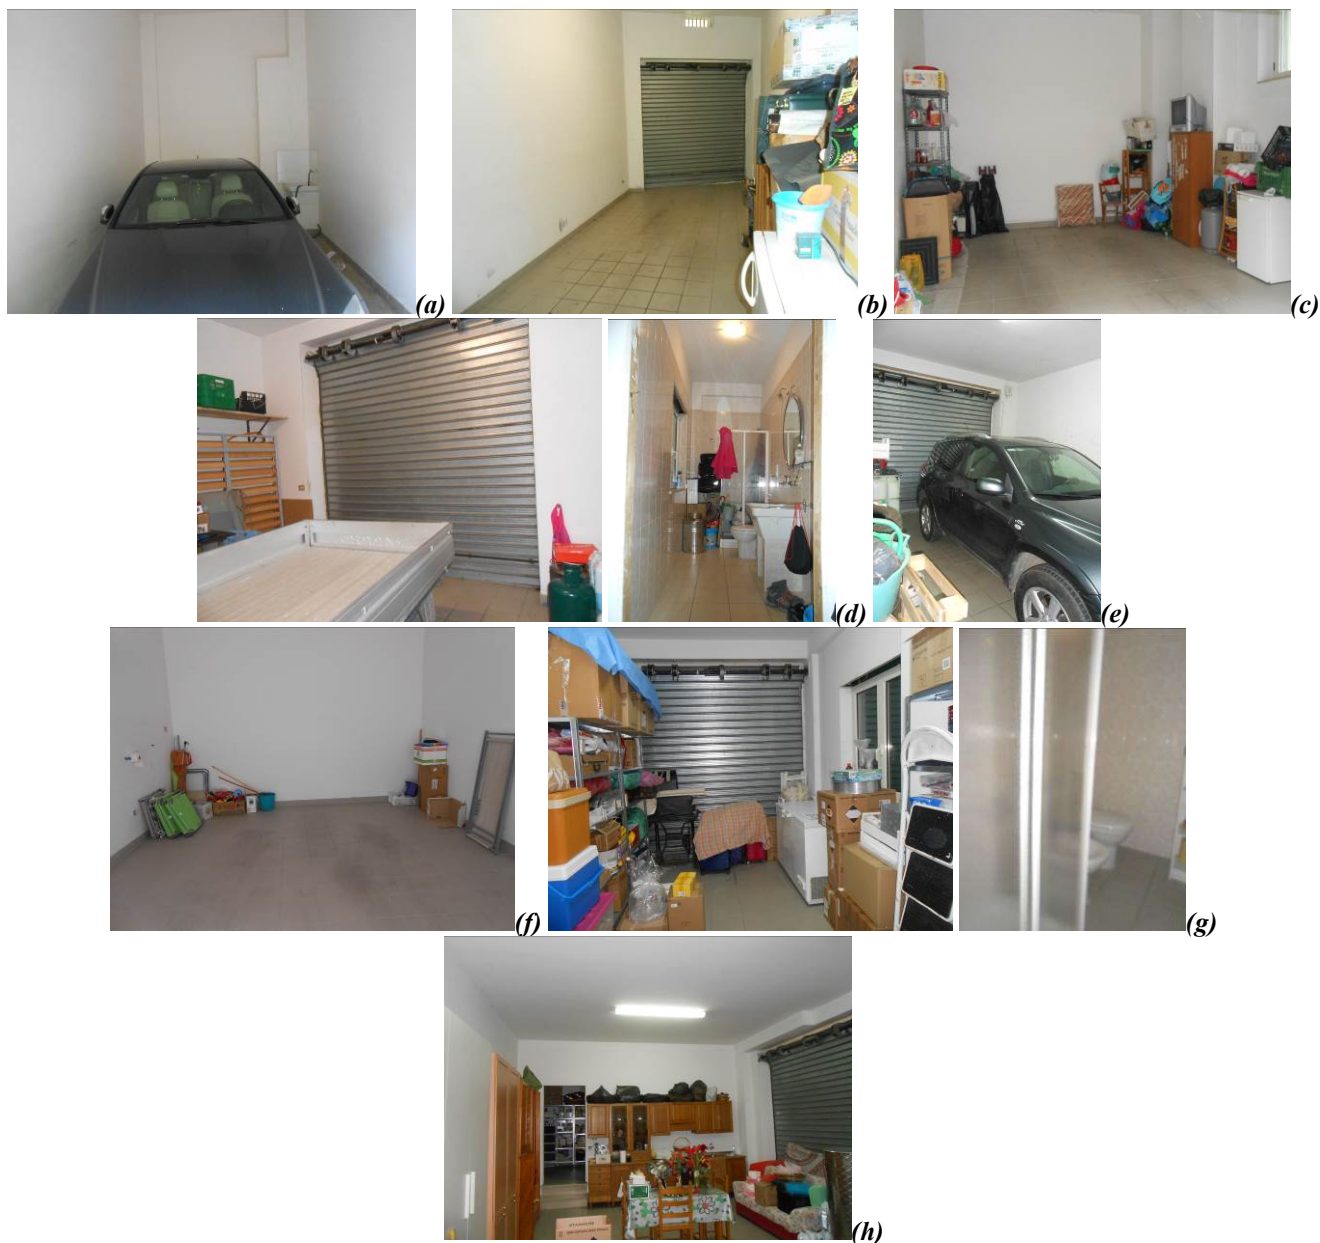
Fotografie dei locali box a pianoterra ubicati in via Giro Esterno nn. 1, 1/A, 1/B, 1/D e 1/E, via G. Rossini nn. 18/F e 18/G, e via Cilea snc: BENE E (a); BENE F (b); BENE G (c); BENE H (d); BENE I (e); BENE L (f); BENE M (g); BENE N (h).
